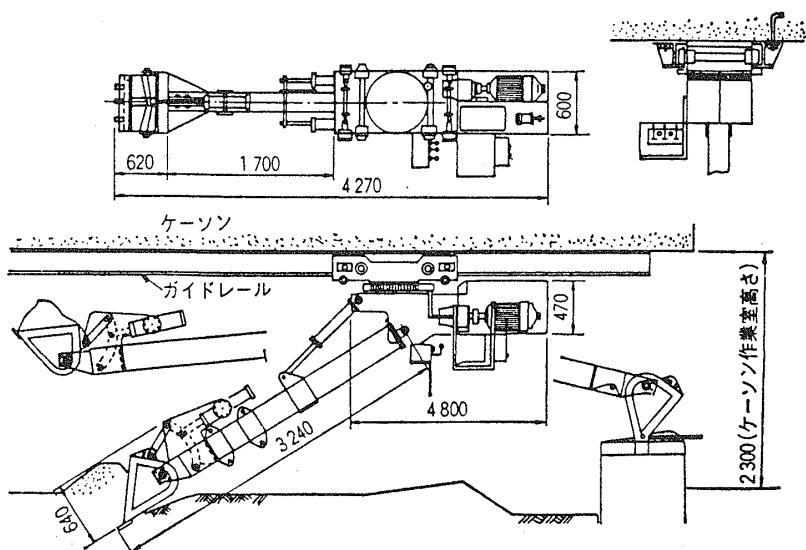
函内電動ブルドーザー¹⁹⁴⁾
